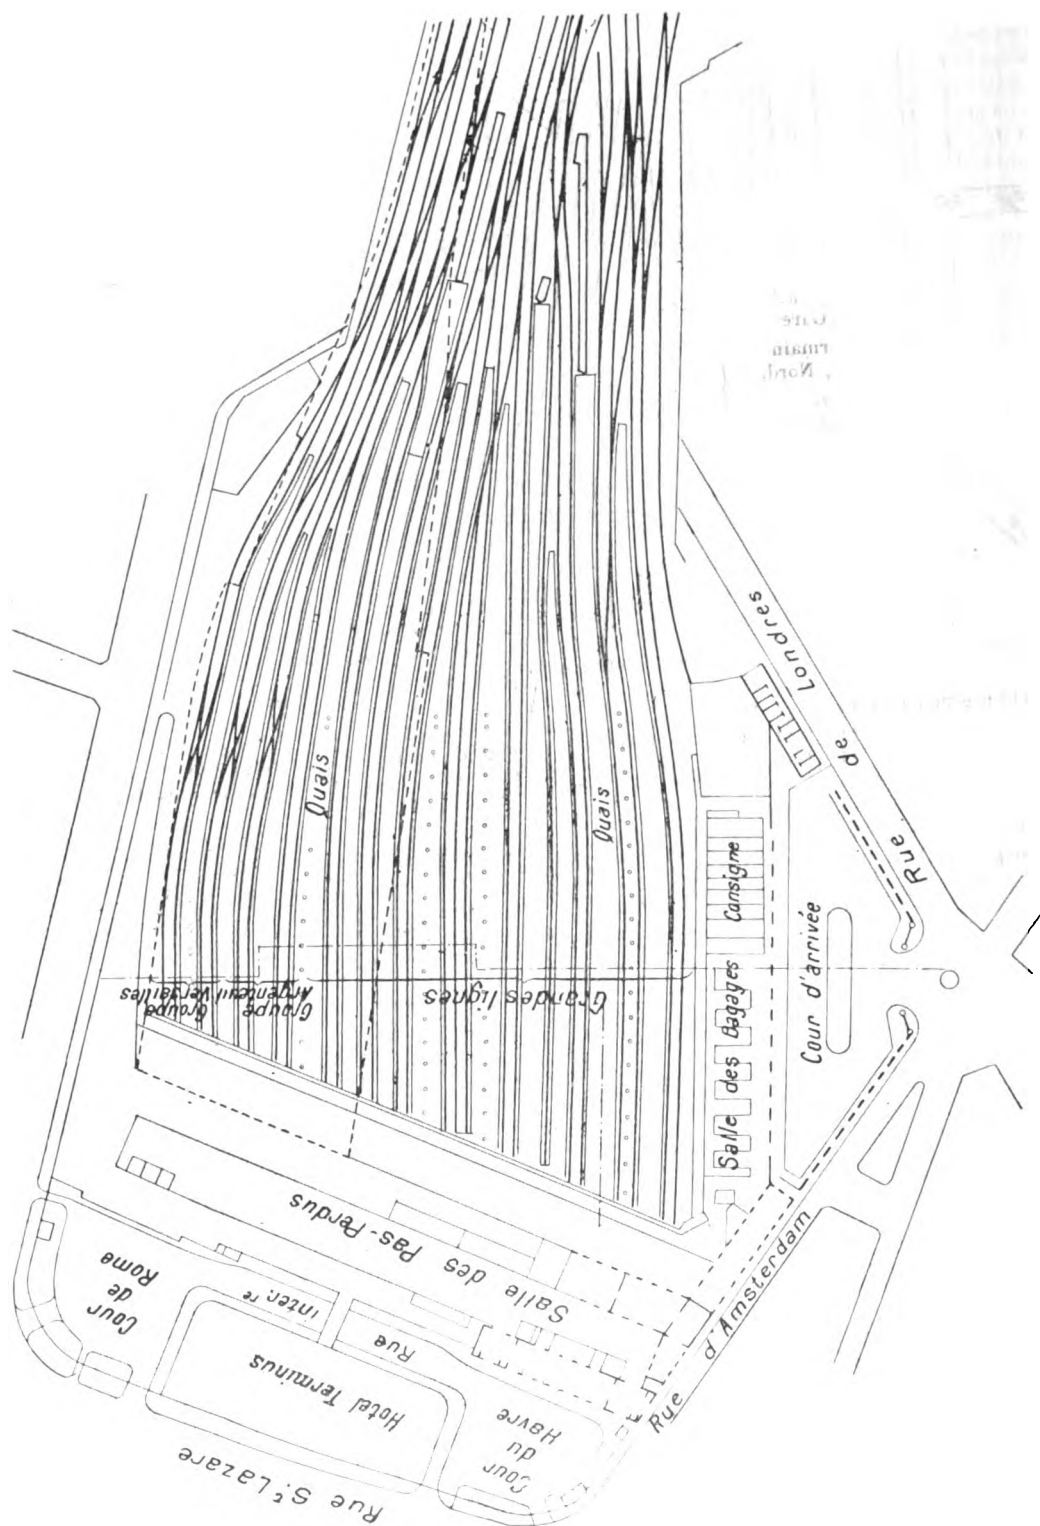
Plan de la gare Saint-Lazare-État futur.
